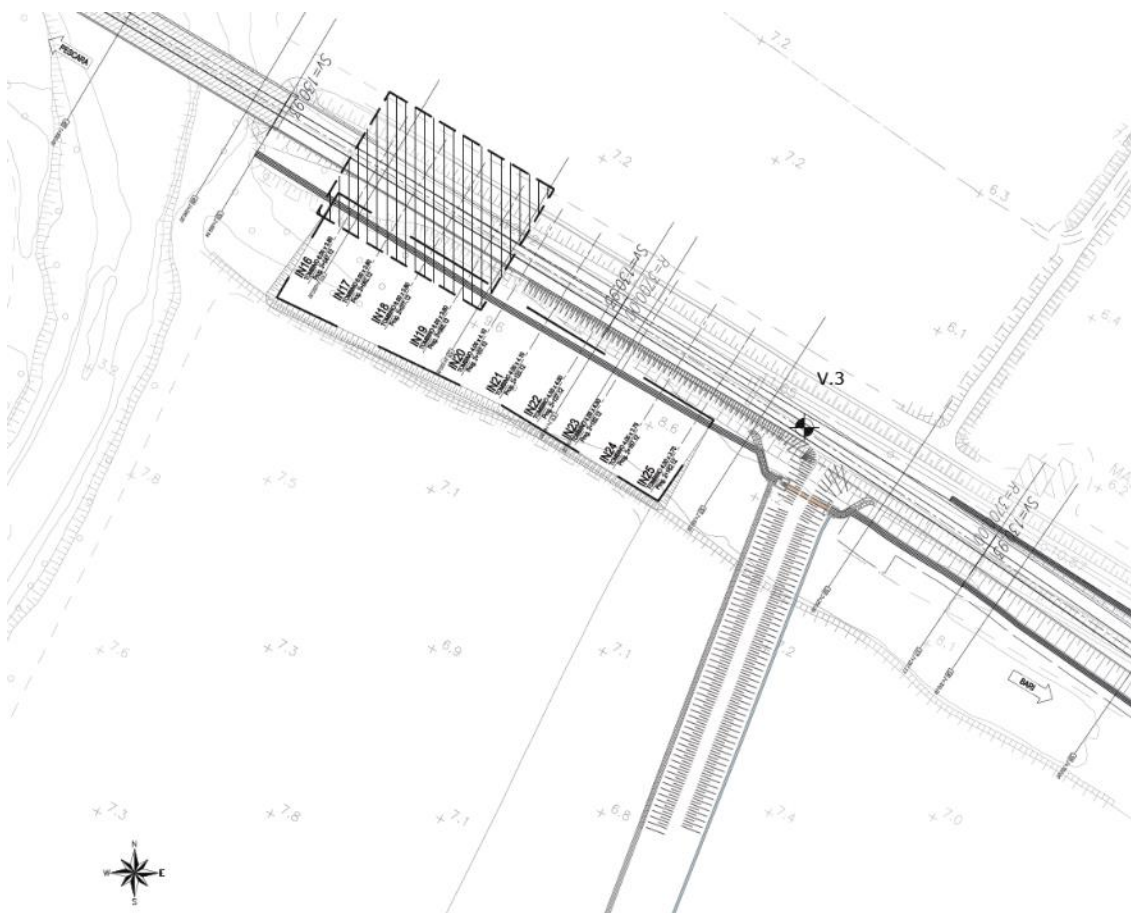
Scatolari in c.a. IN16, IN17, IN18 ed IN19 – Vista Planimetrica
